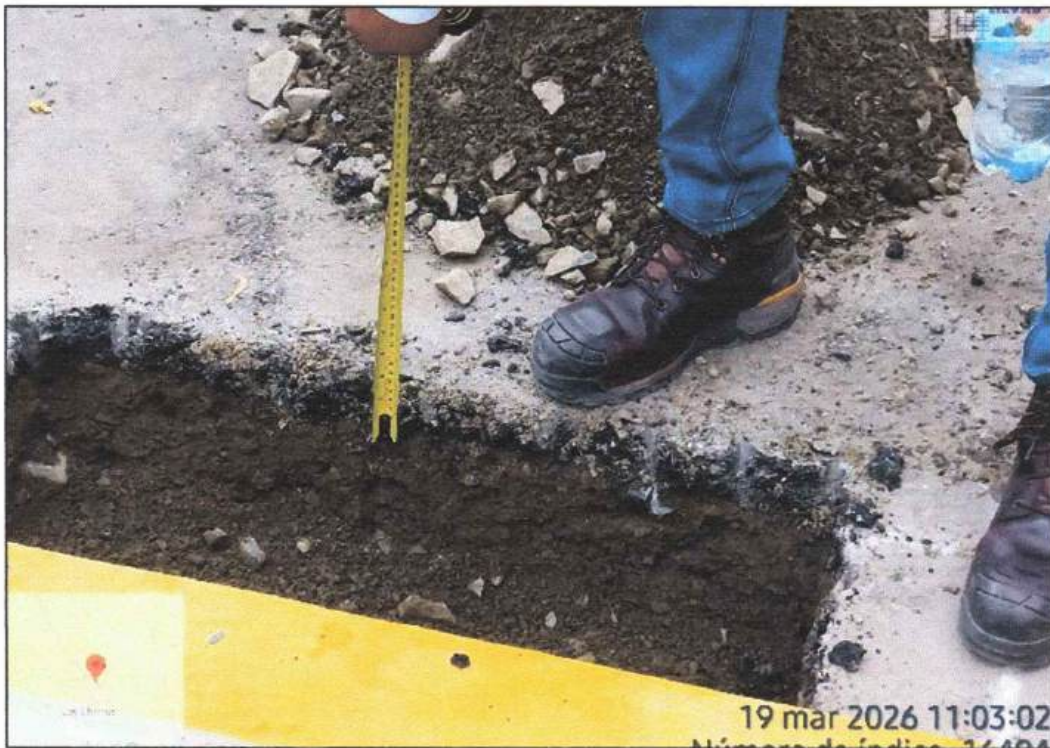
y N°30: No se realizó el cambio de alcantarilla, en esa razón. Existe la colmatación en las cajas de registro de viviendas, lo que puede colapsar el sistema de colectores (y reduciría la vía útil del pavimento)
